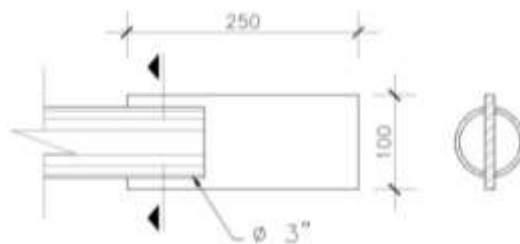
Alzado y Sección de nodo de los elementos de arriostramientos (Predimensionado)
